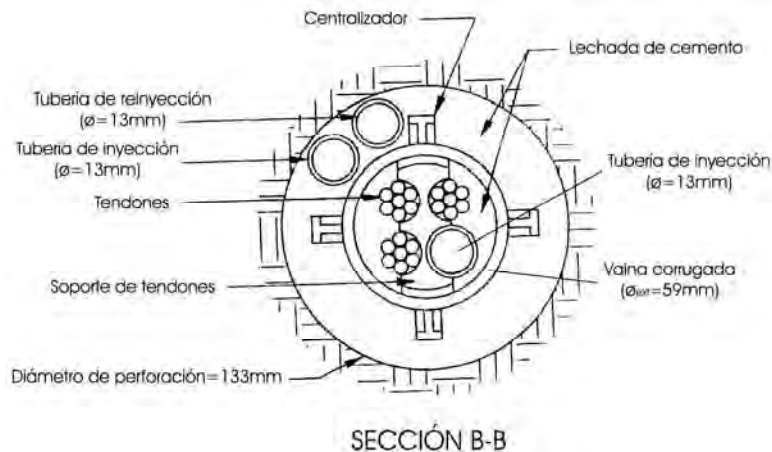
SECCIÓN TRANSVERSAL ANCLAJE EN ZONA DE BULBO
